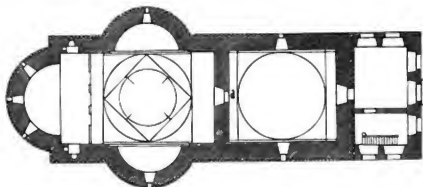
(Johannes Kirche in Sereth, Grundriss.)
